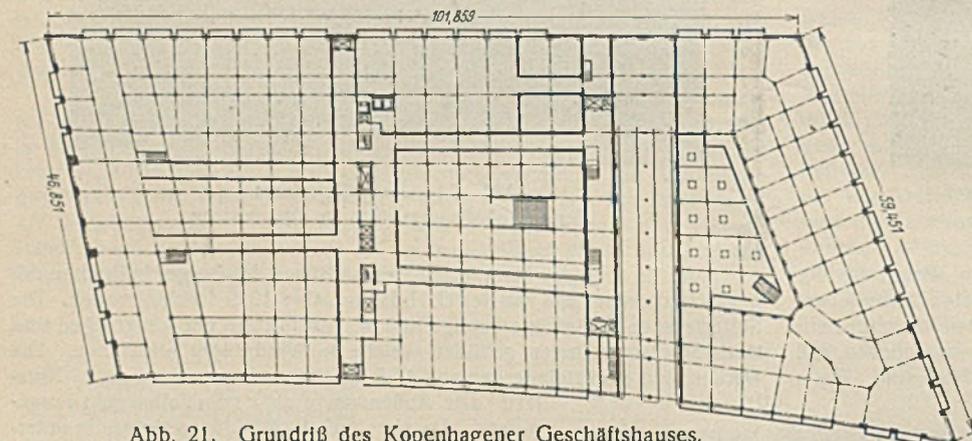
Grundriß des Kopenhagener Geschäftshauses.
